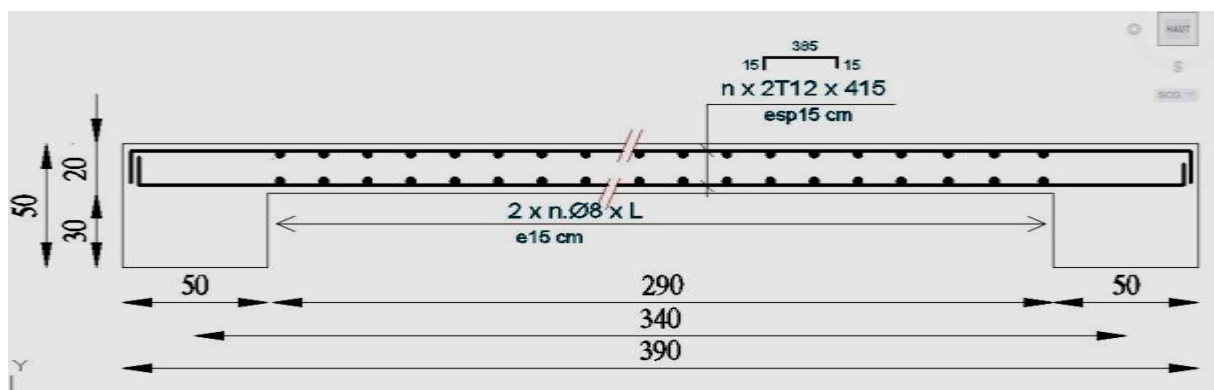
Dessin du ferrailage du voile de contreventement.
